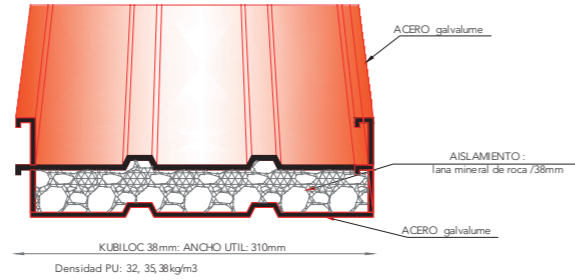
Esta figura muestra el detalle de cubierta el TNBC/ Kubiloc total 38.
